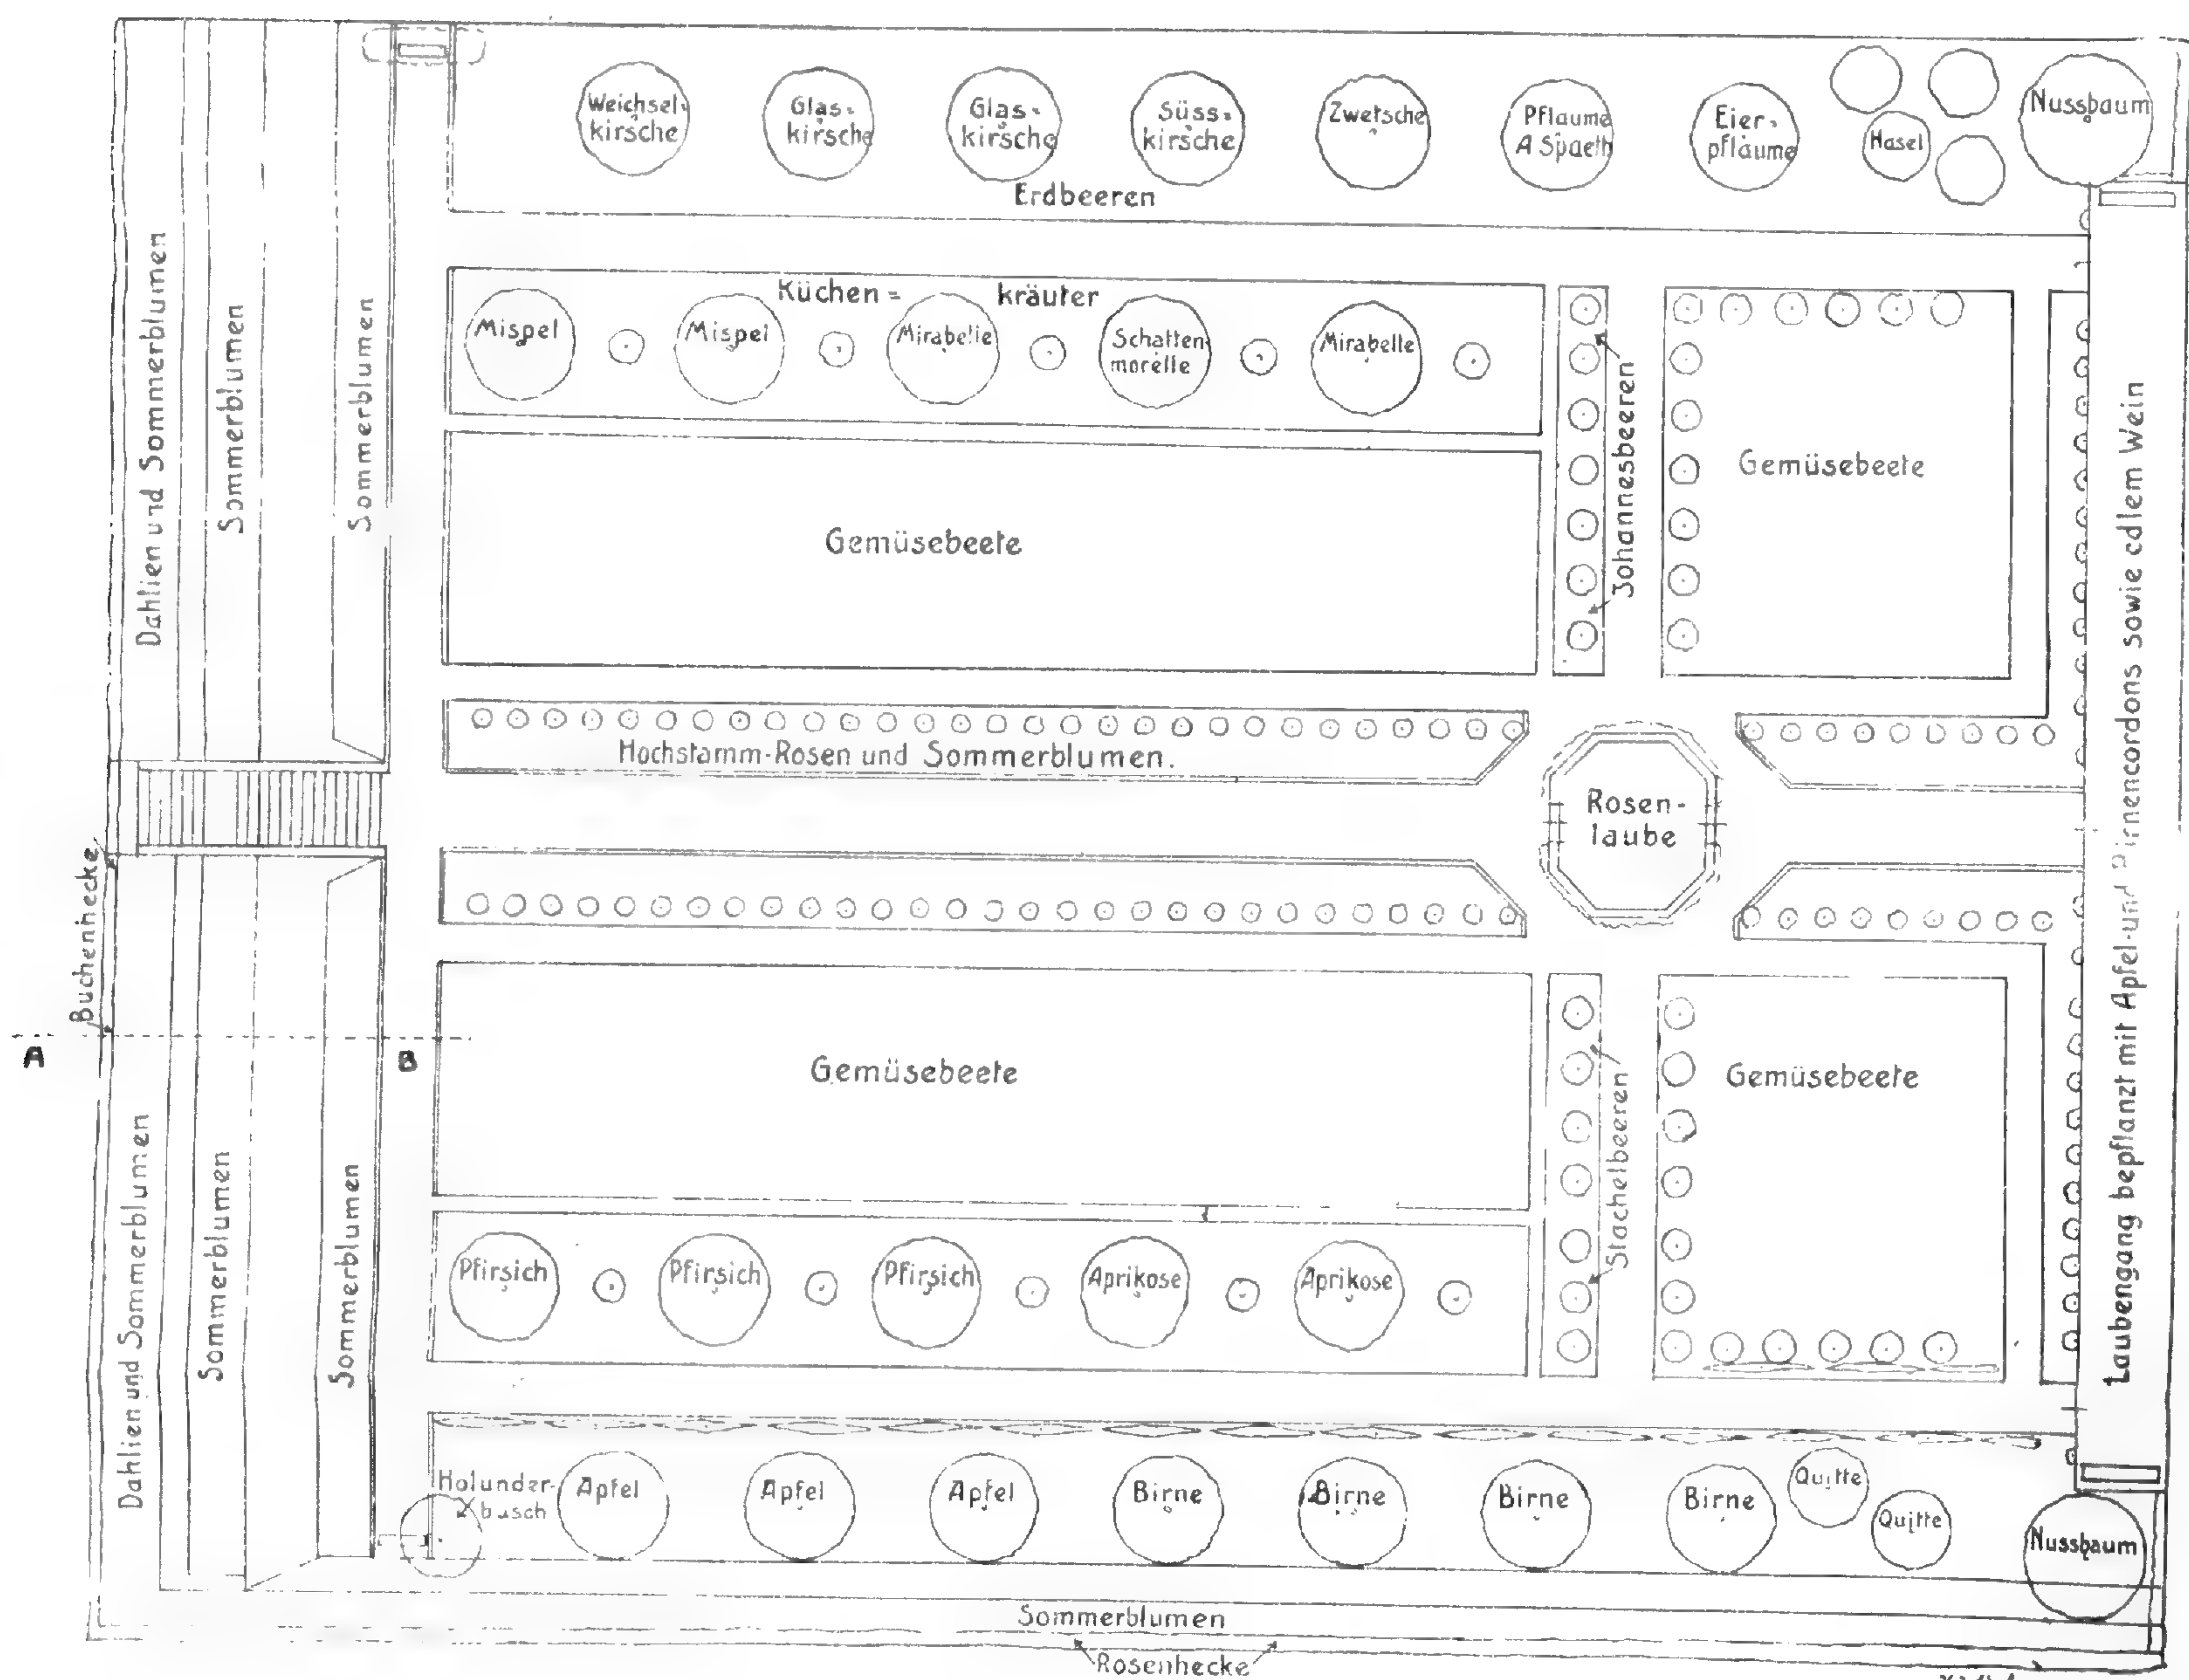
Grundriss des „Haus- und Nutzgartens“.
